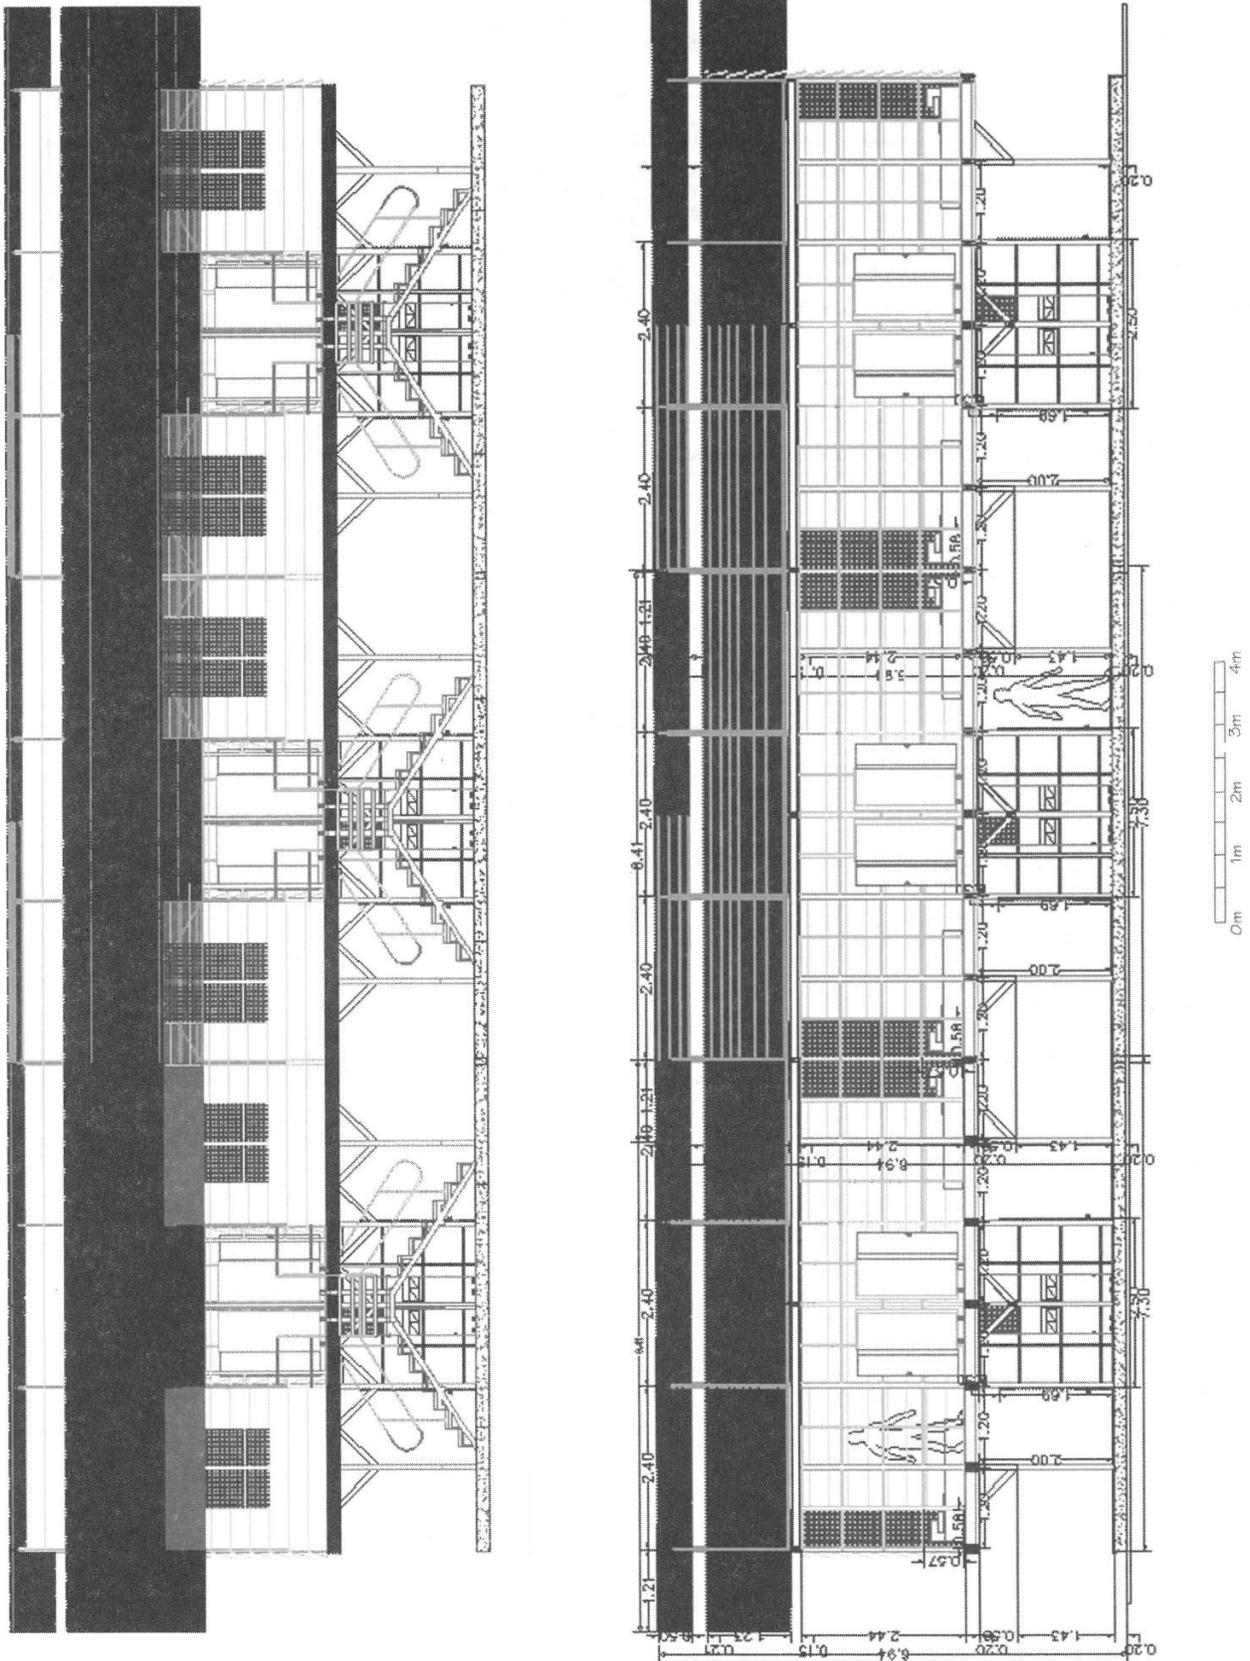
Elevación frontal y corte longitudinal A-A. Propuesta casa Bache IAT
